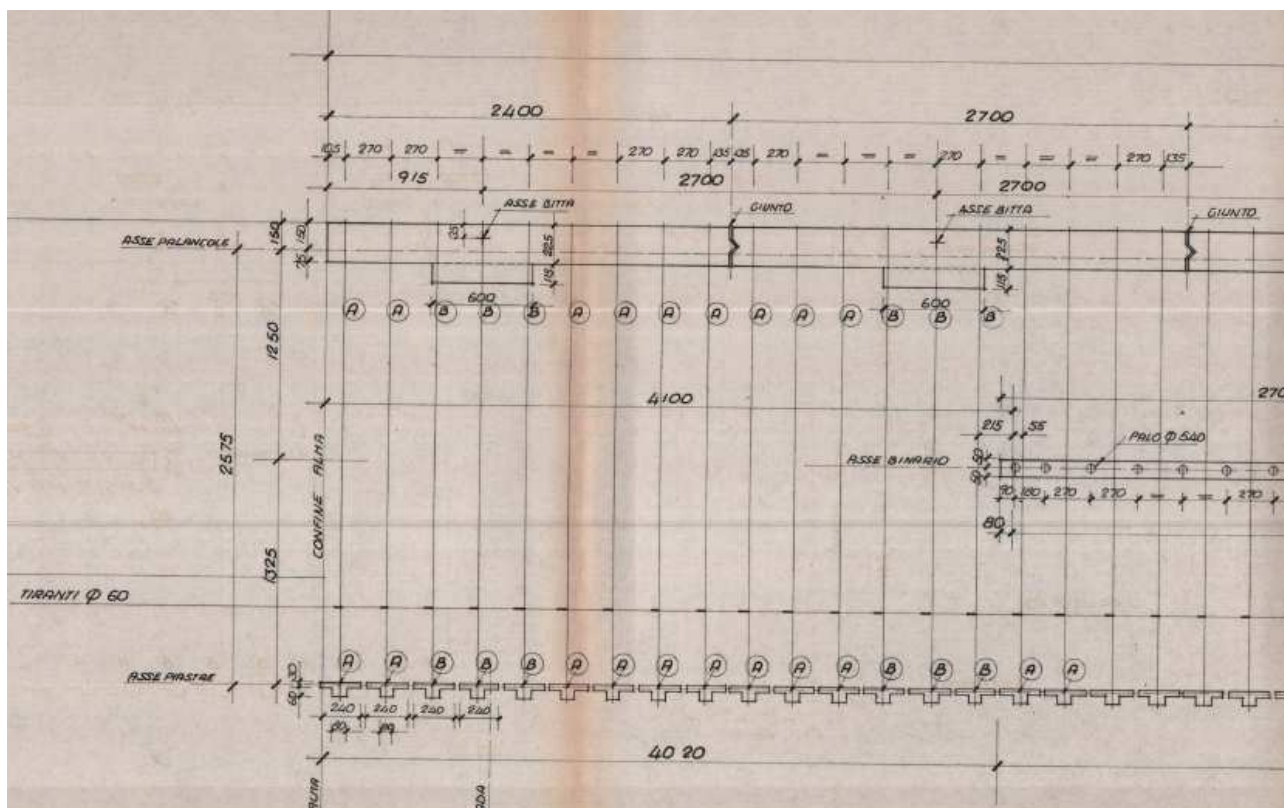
Stralcio planimetrico del banchinamento (dal progetto del 1977)
